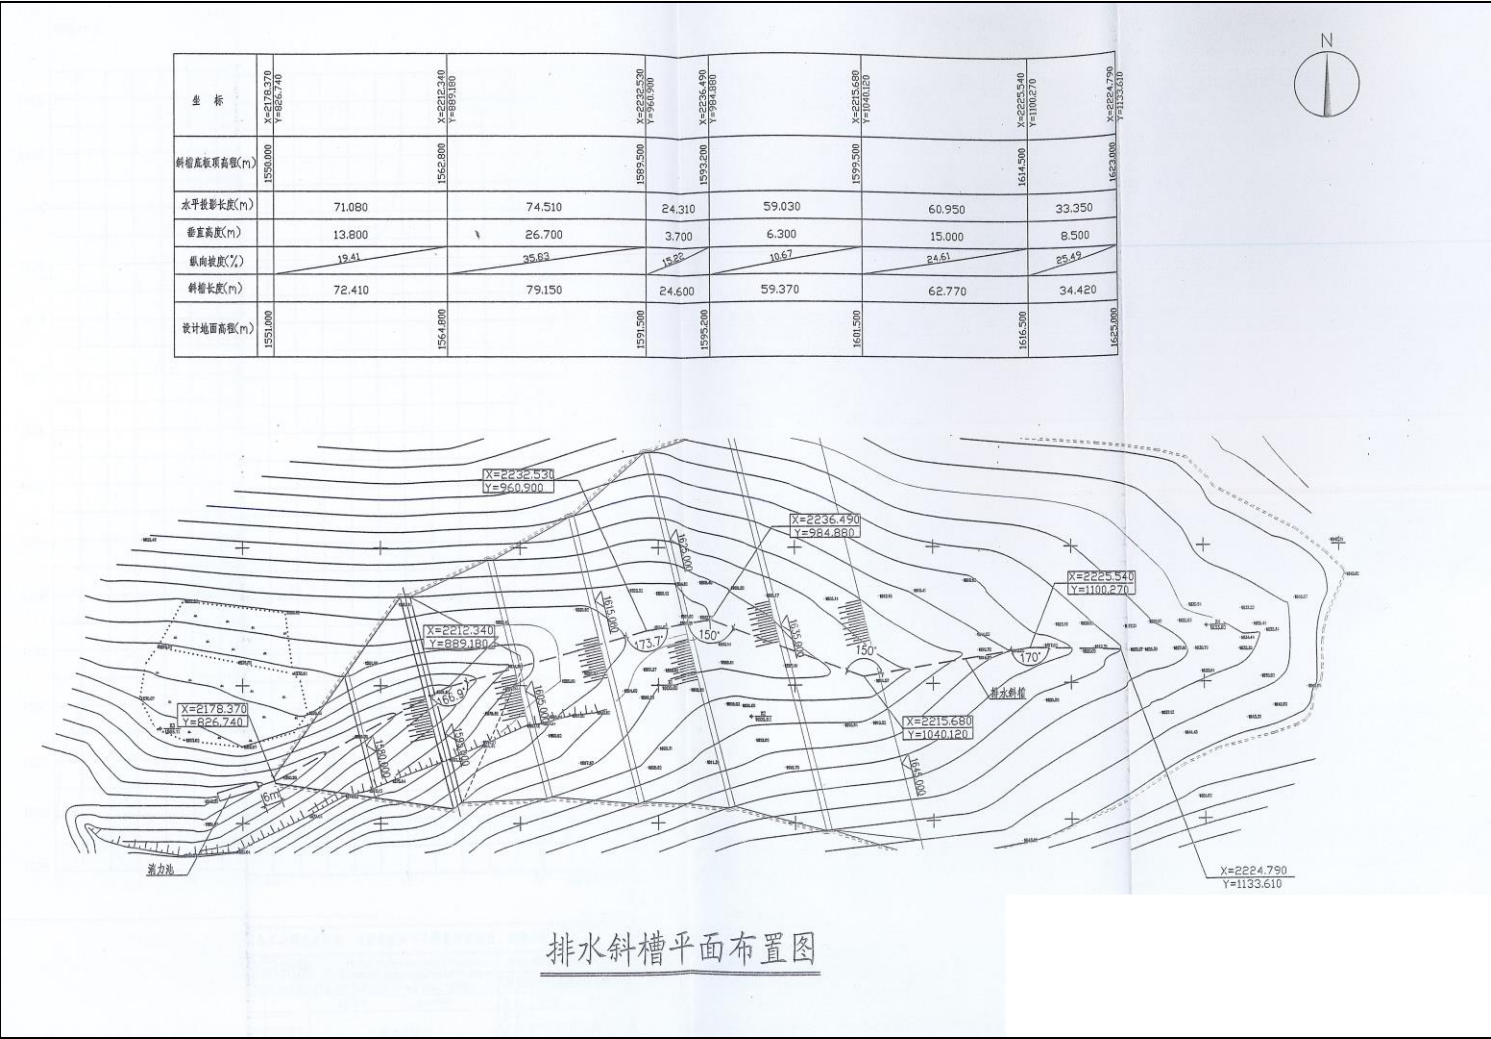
侯家沟尾矿库排水斜槽平面布置图
